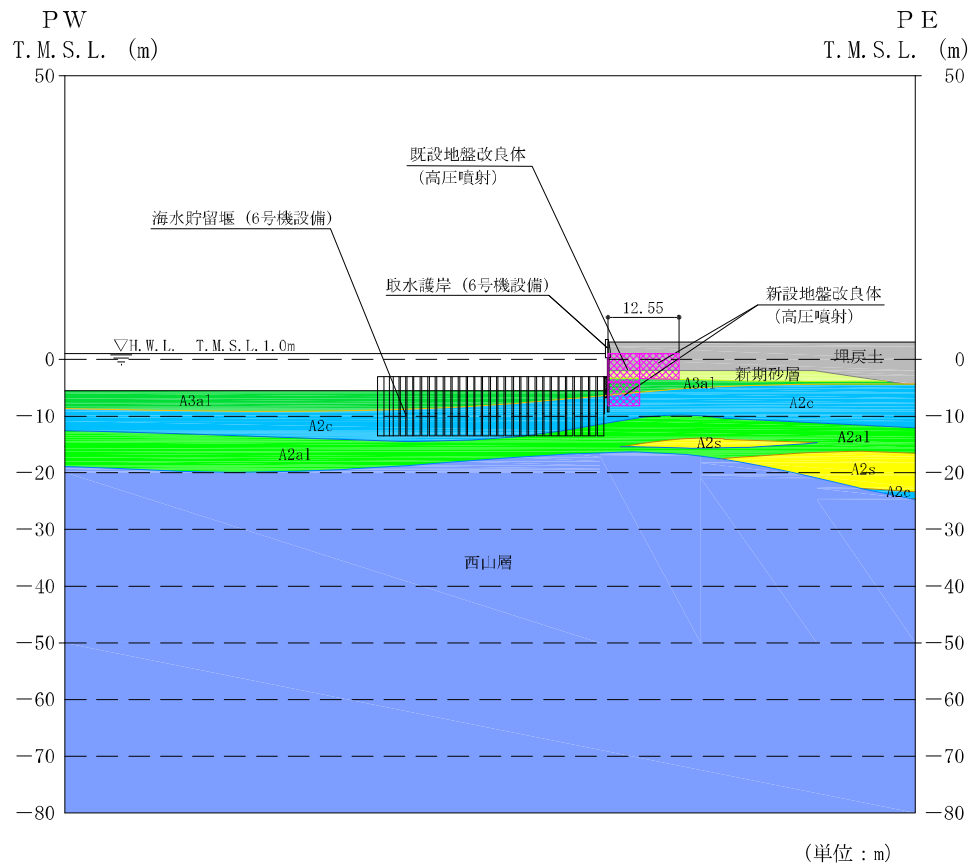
取水護岸 (6号機設備) の評価対象断面図 (A-A断面)
